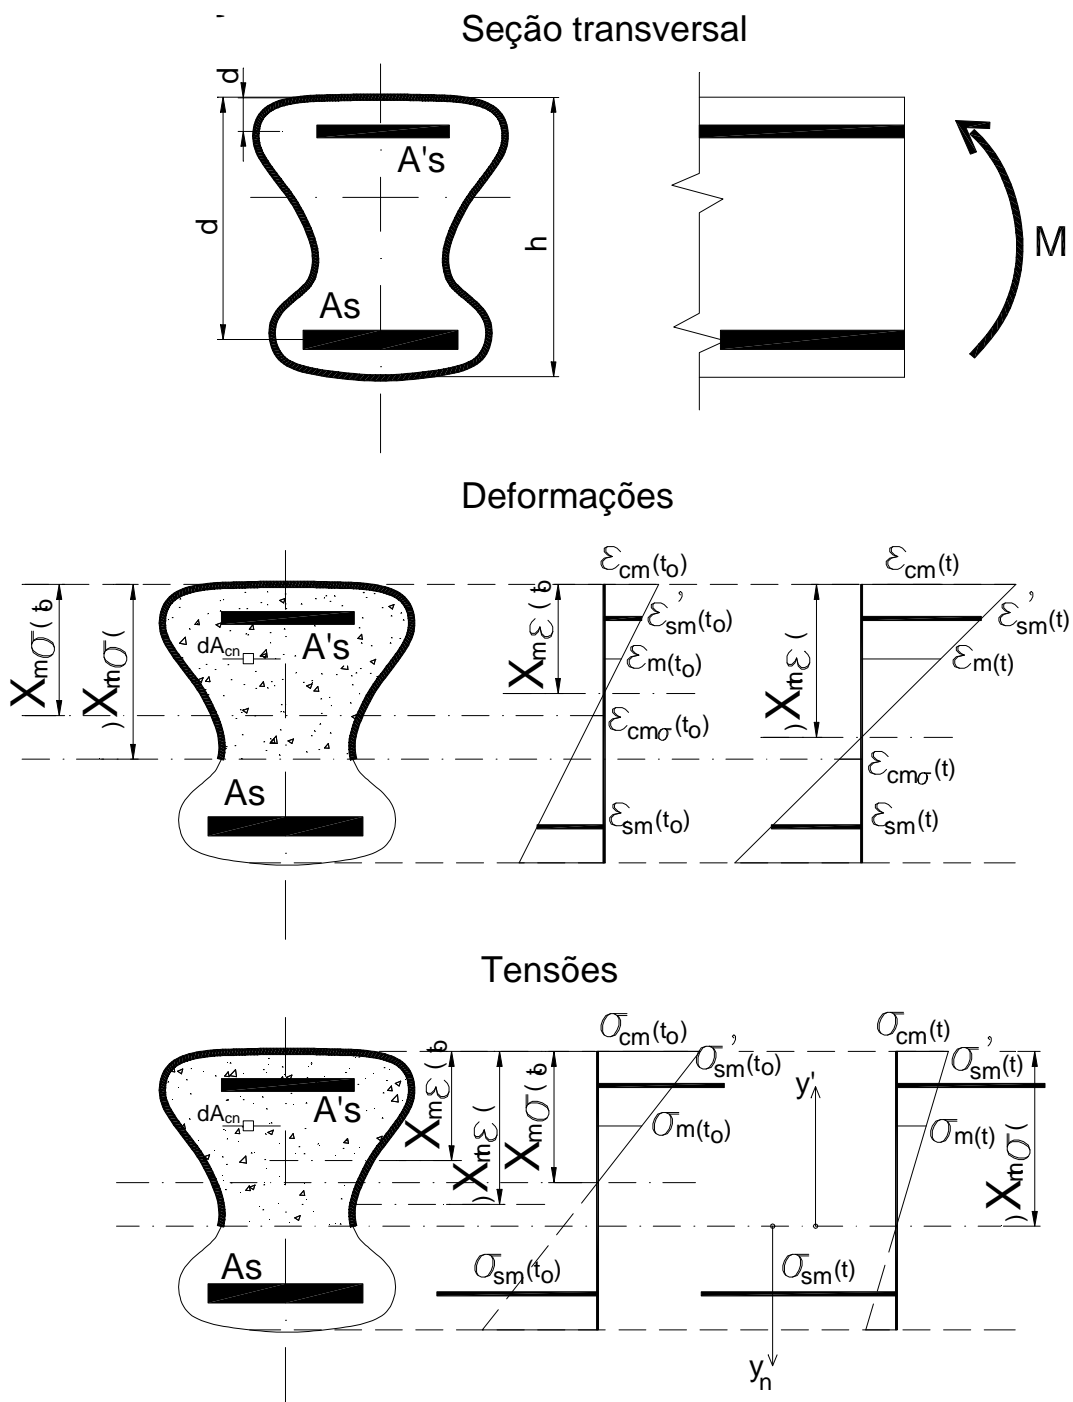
Tensões e deformações para os instantes de tempos “ t_0 ” e “ t ” para uma seção fissurada de concreto armado.
